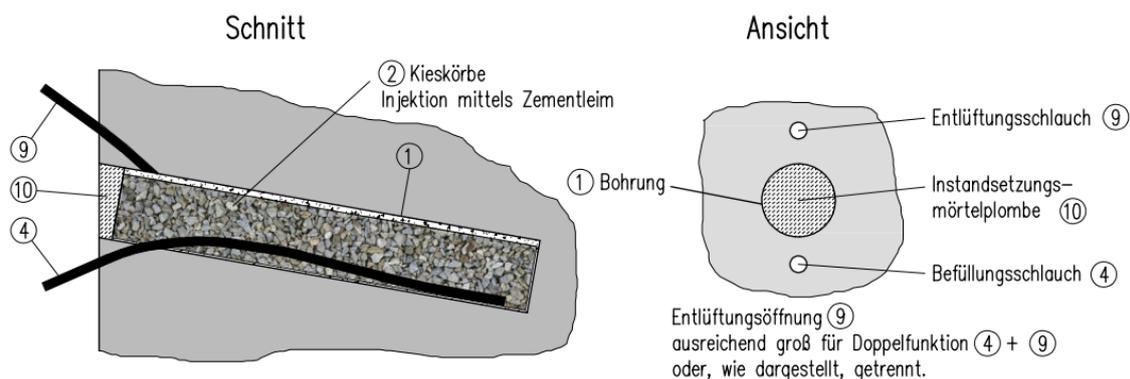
Variante - Betonersatz im Handauftrag in der Betonrandzone und Bohrungen für Befüllungs- und Entlüftungsschläuche
